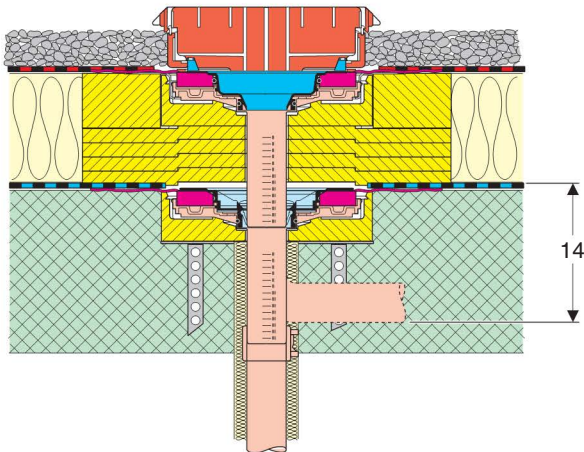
Einbau mit Geberit Pluvia Einbauständer und Pluvia Grundelement
